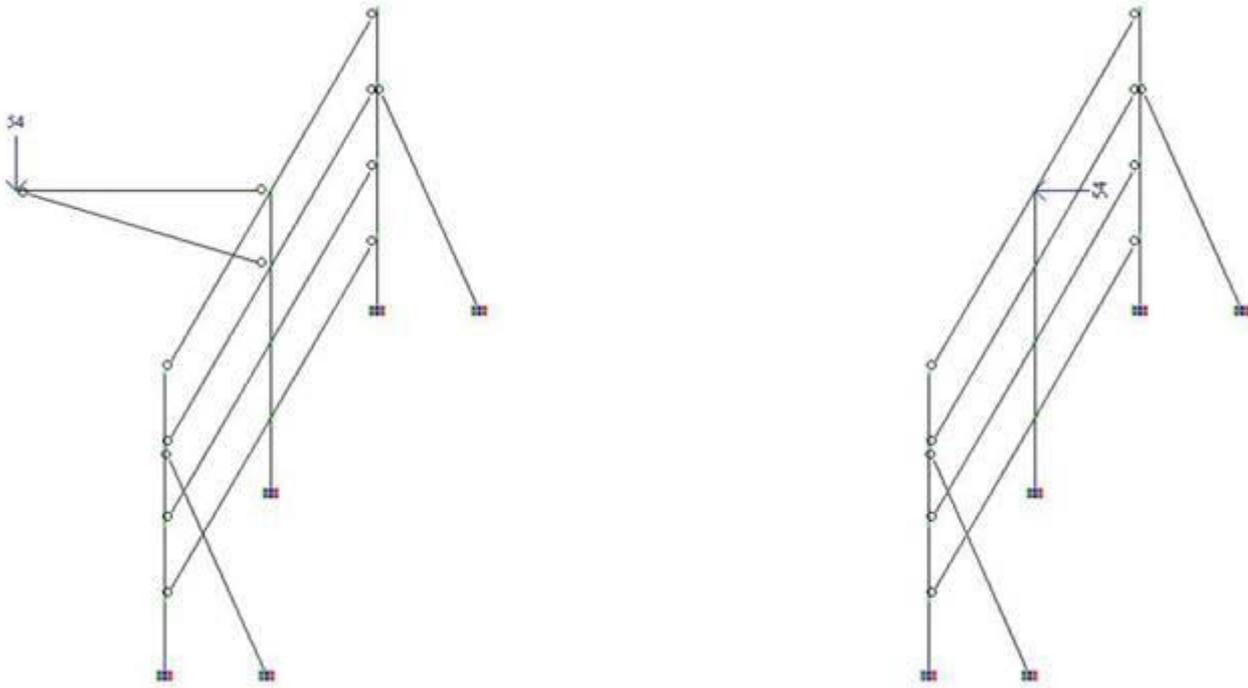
Расчетные схемы ограждения кровли при двух вариантах загрузки.
